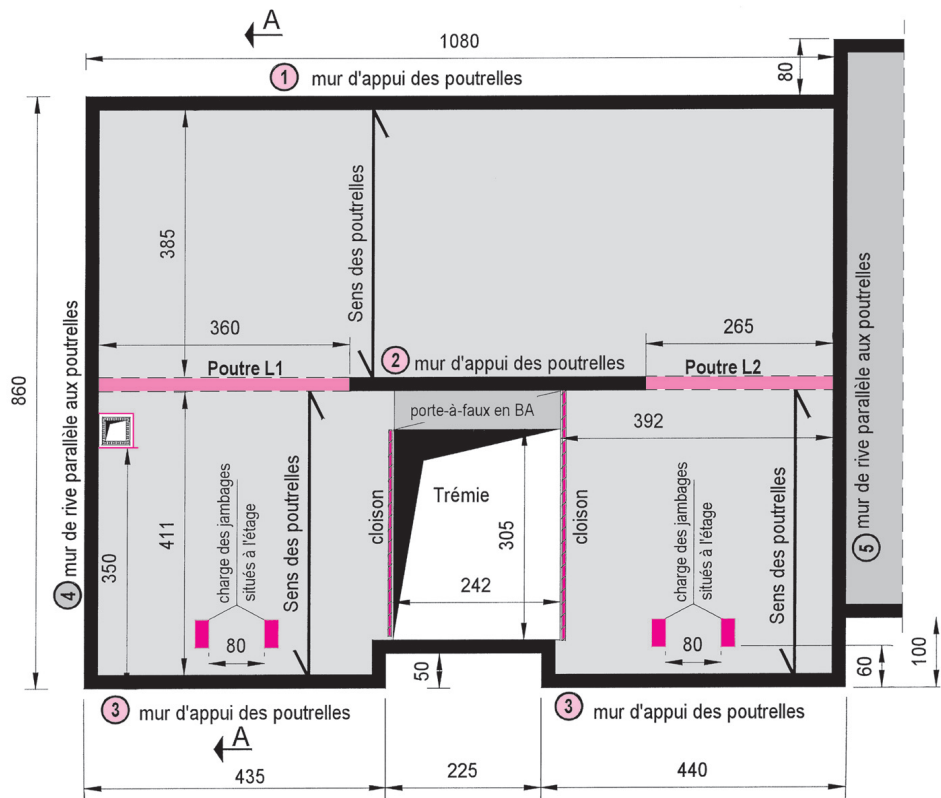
Vue en plan schématique du plancher haut du rez-de-chaussée
